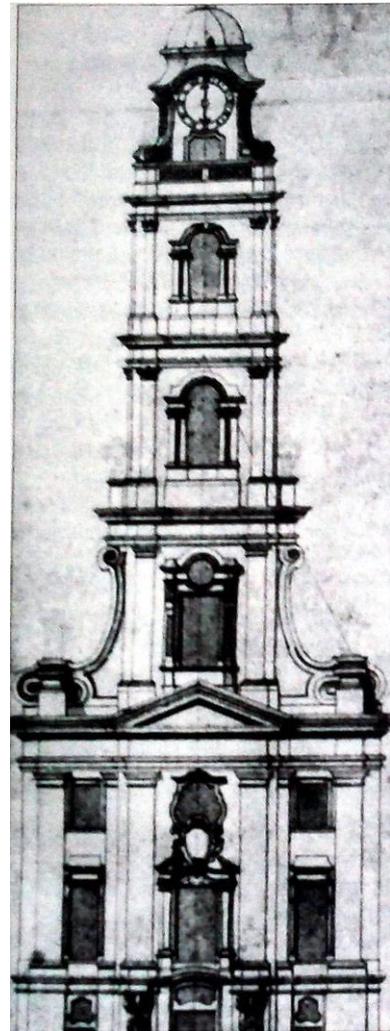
Josef Munggenast, Aufriss einer eintürmigen Kirchenschauwand, 1722, Foto nach einer verschollenen Planzeichnung.
